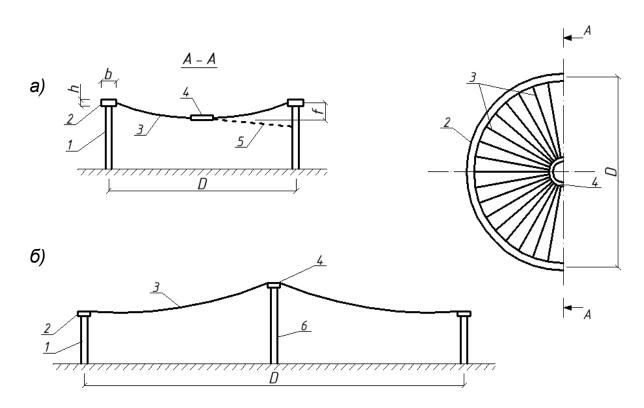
Схемы висячих оболочек с радиальными вантами: вогнутое (а) и шатровое (б) покрытия; 1 – колонны, 2 – наружное опорное кольцо, 3 – ванты, 4 – центральное кольцо, 5 – водоотводящая труба, 6 – центральная стойка в виде колонны
